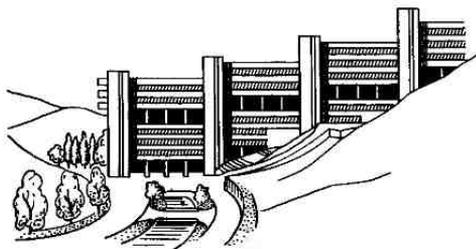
Пример ступенчатого дома на крутом склоне
